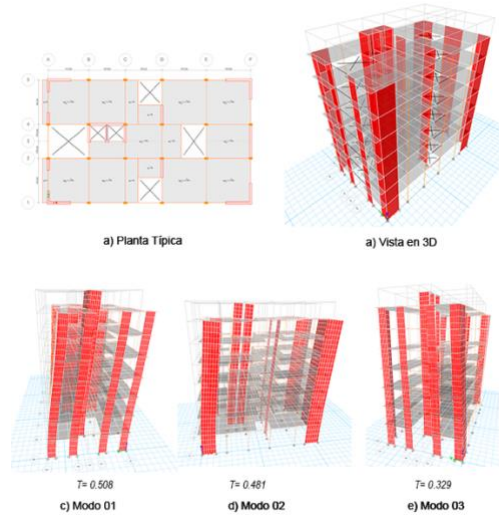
Figura II.- Planta estructural, modelo 3D y modos de vibración.
